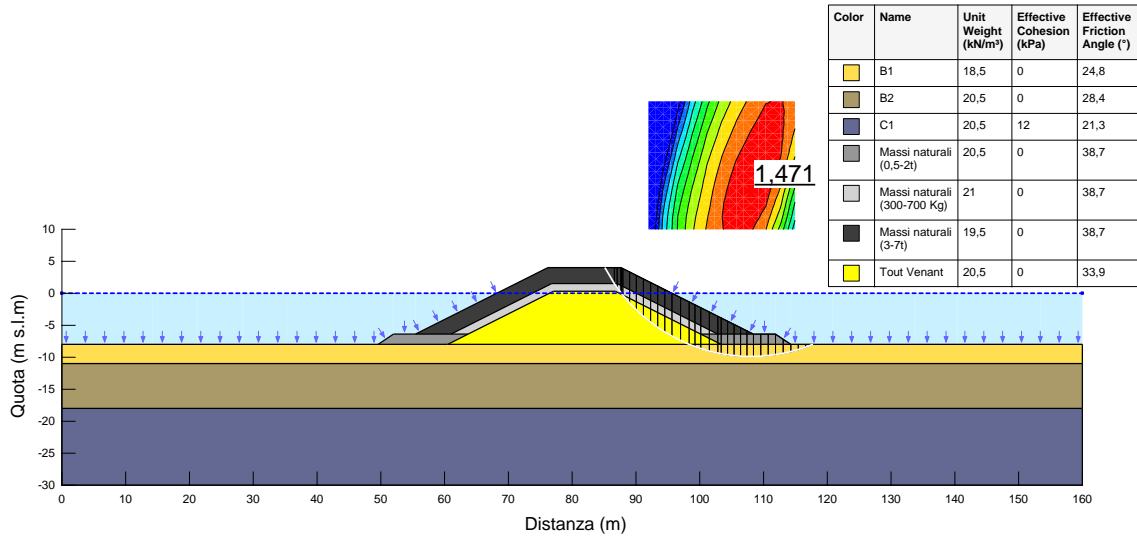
Sezione A – SLU-GEO 2 – Superficie critica destra
